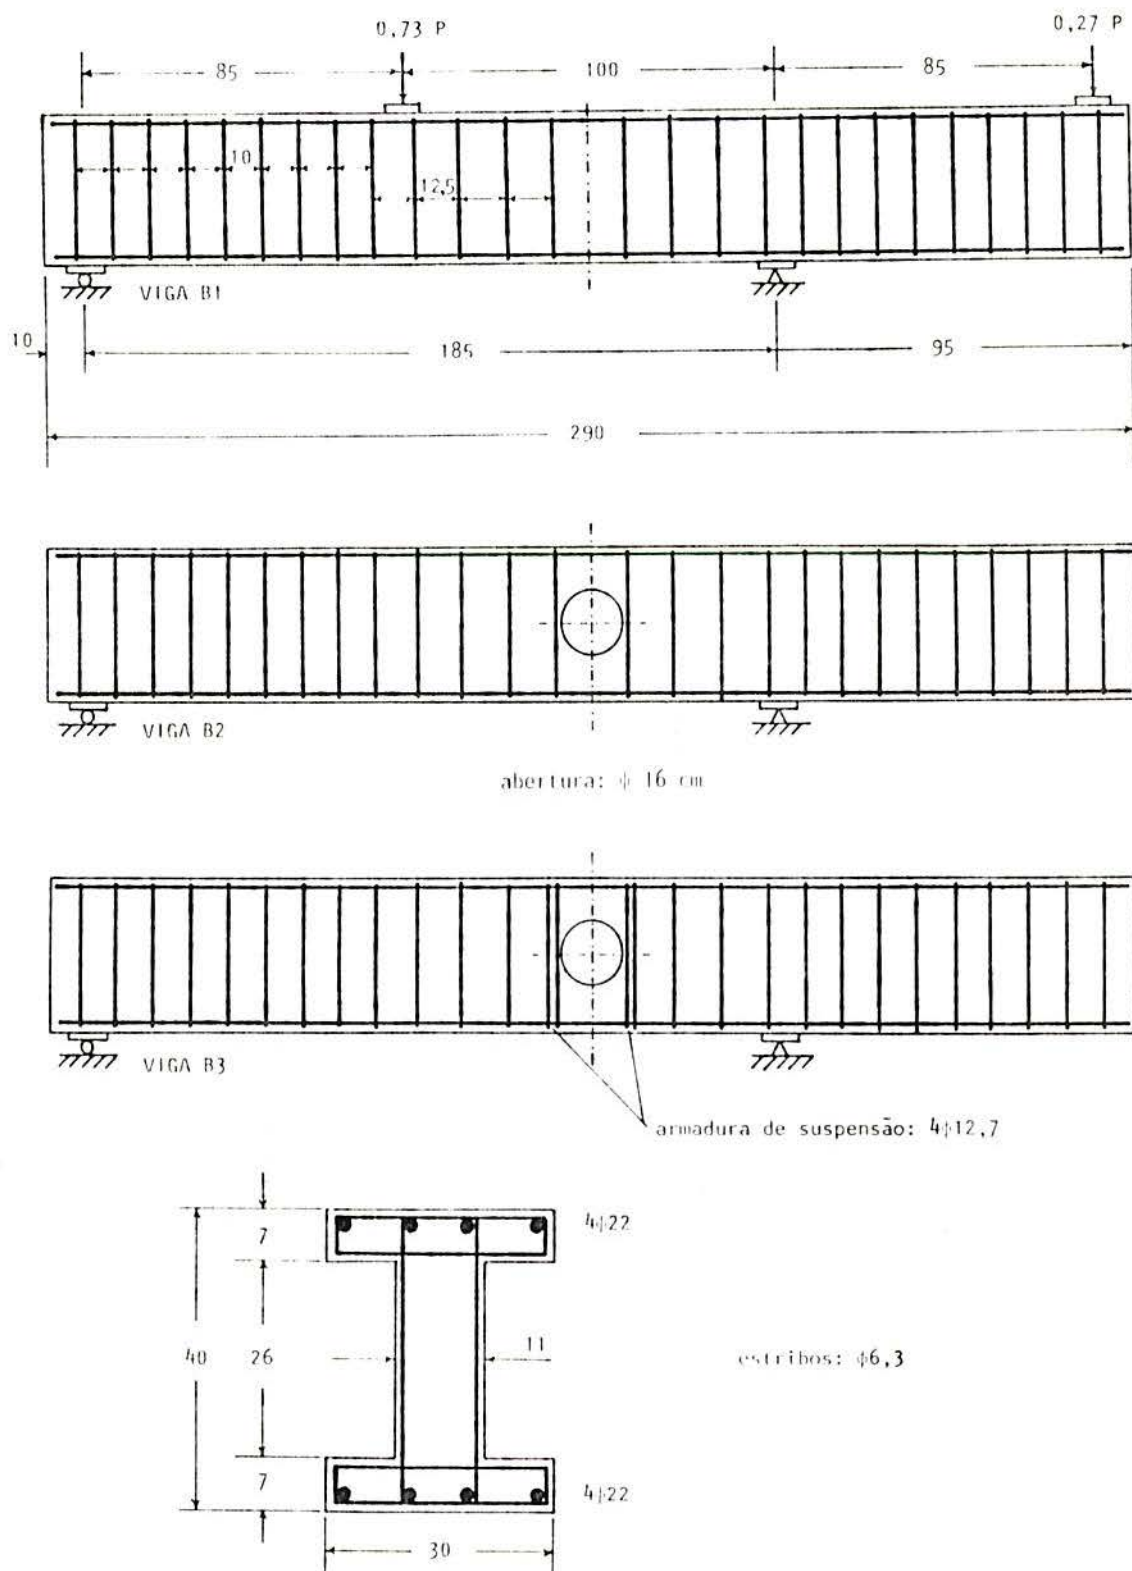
Detalhamento das vigas B1, B2 e B3
